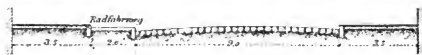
Straße mit Vorgärten und einseitigem Baumsatz. M. 1 : 200.
